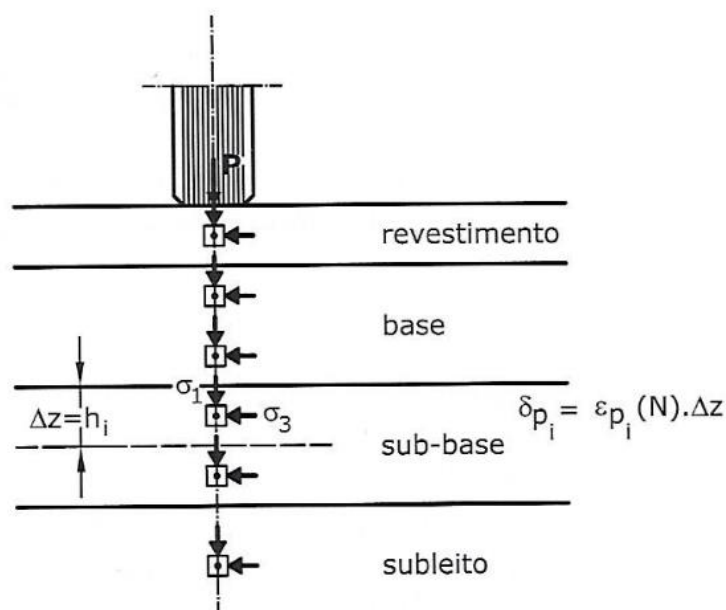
Deformação permanente ou plástica por camada do pavimento
